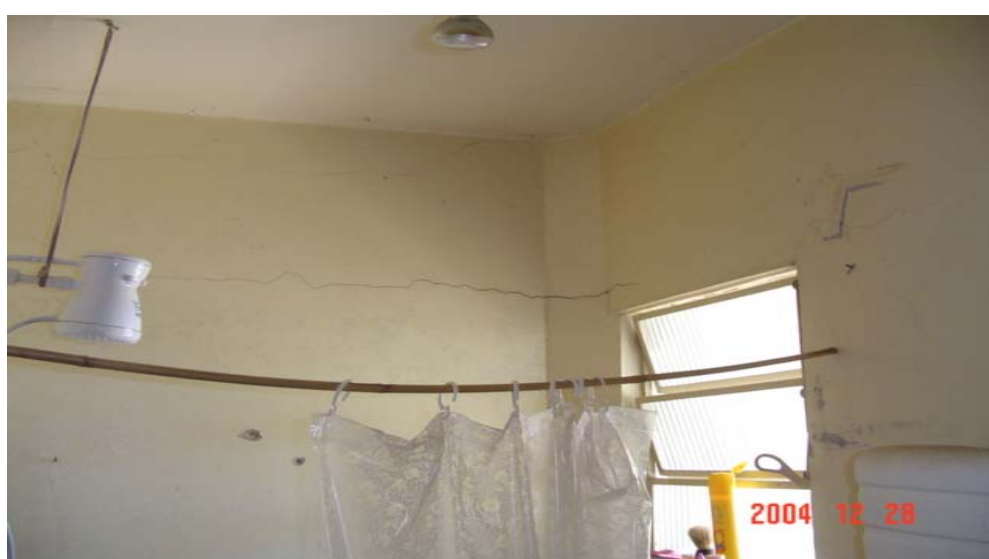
Fissuração junto à janela no condomínio Costa e Silva
